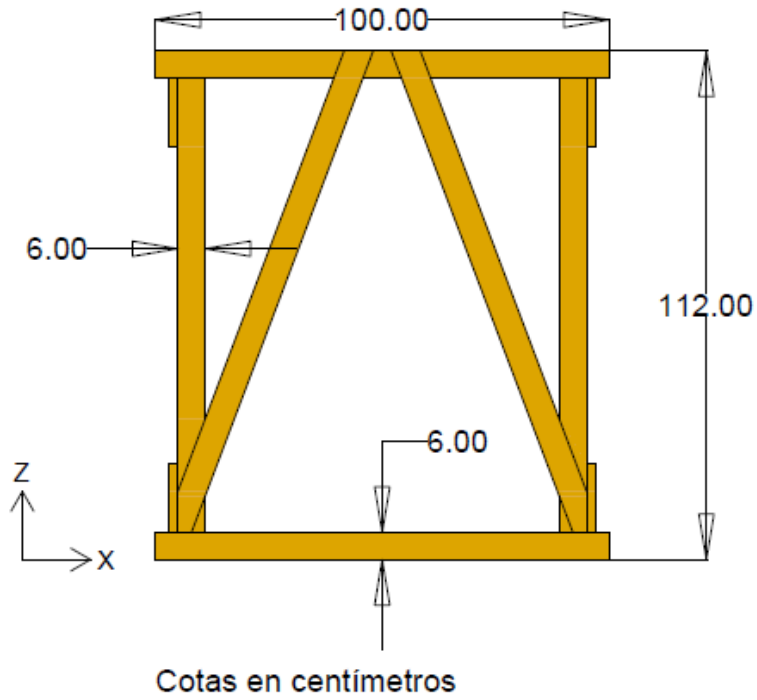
Croquis de vista de perfil de la estructura, plano XZ.
